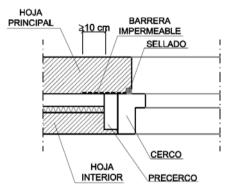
Ejemplo de encuentro de la fachada con la carpintería.
